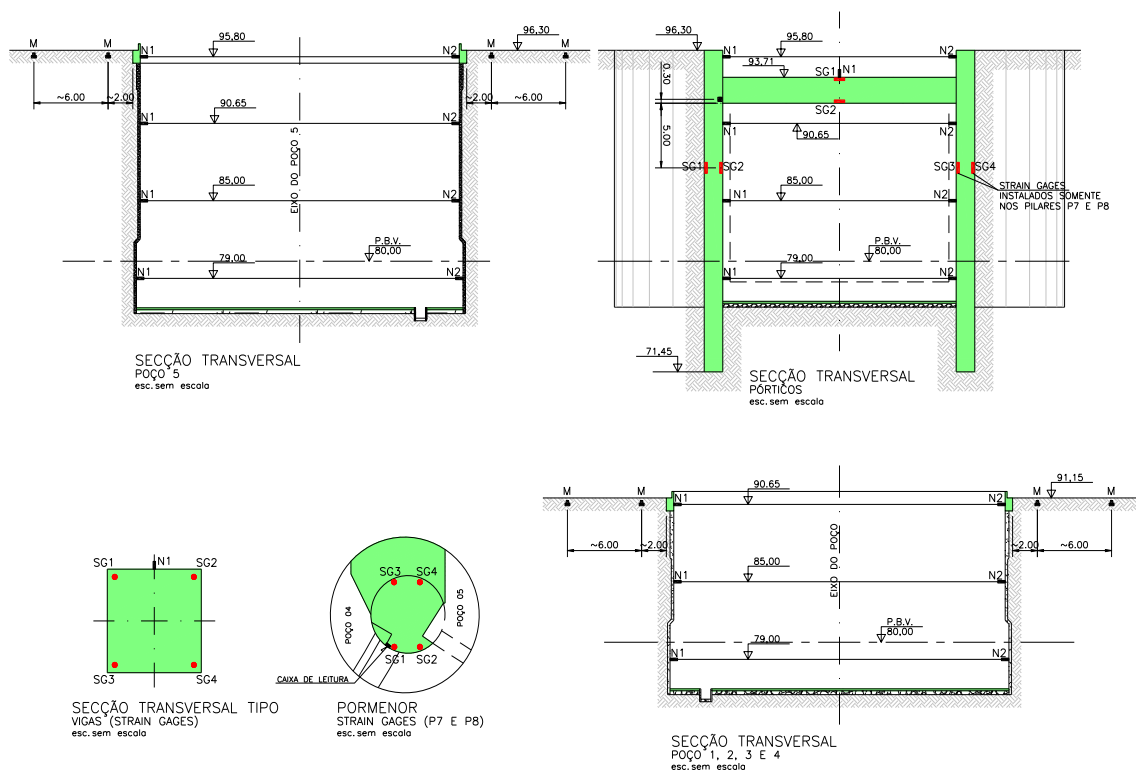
Instrumentação da Estação da Reboleira – perfil (CJC, 2009).
